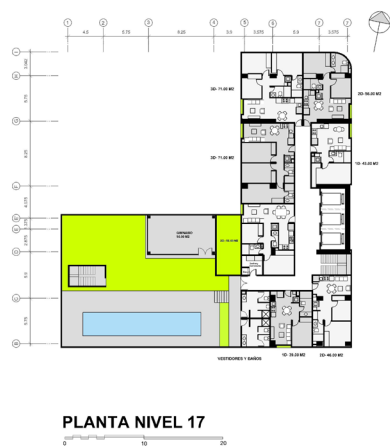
Plantas Arquitectónicas y planta de modulación estructural que muestra la combinación de columnas, vigas y muros de corte.
